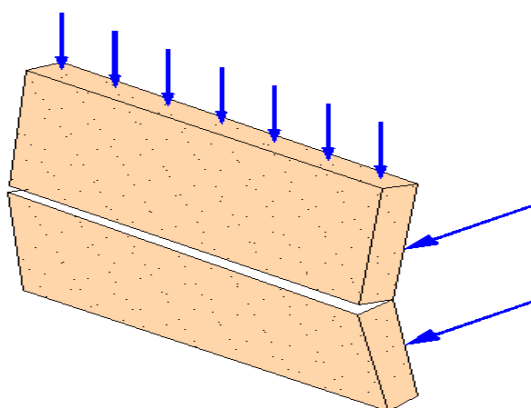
Rupture à mi-hauteur due à la flexion hors plan.
